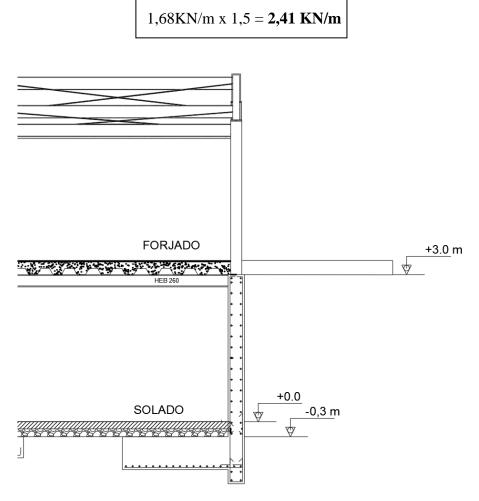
Sección solución adoptada muro ménsula. Fuente: Elaboración propia
